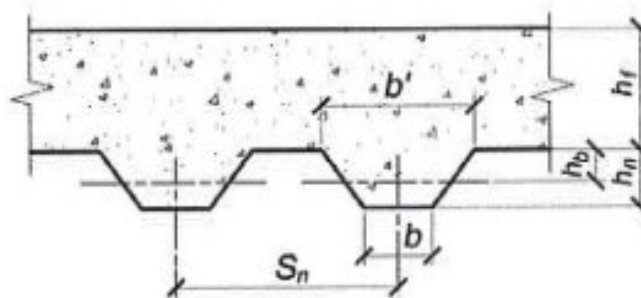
К расчету сталежелезобетонного перекрытия
